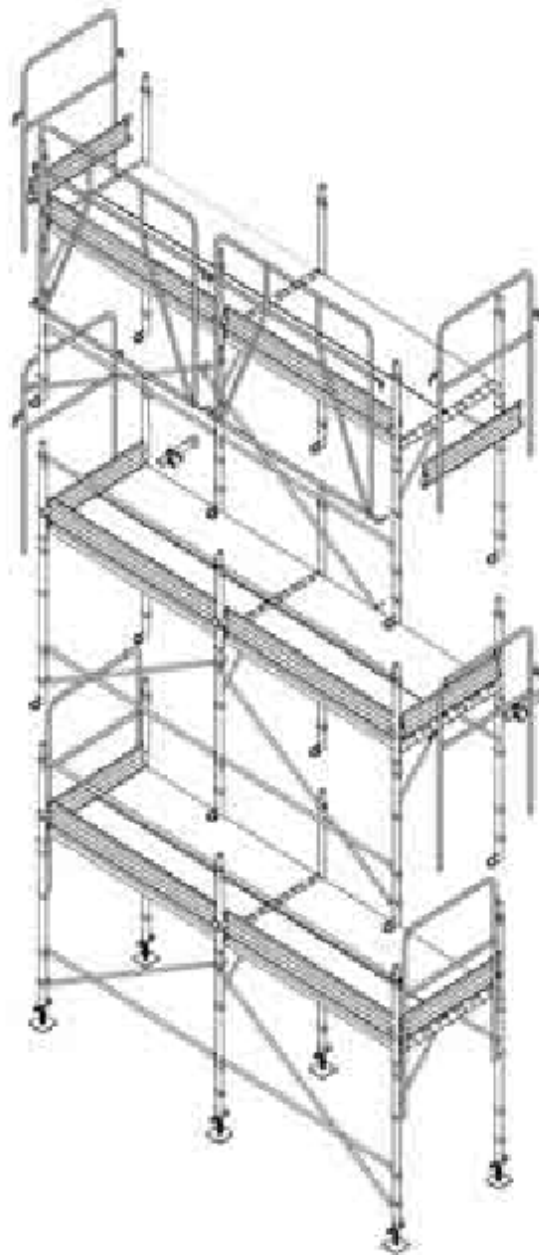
Esempio di ponteggi a telai con parapetto di protezione collettiva
